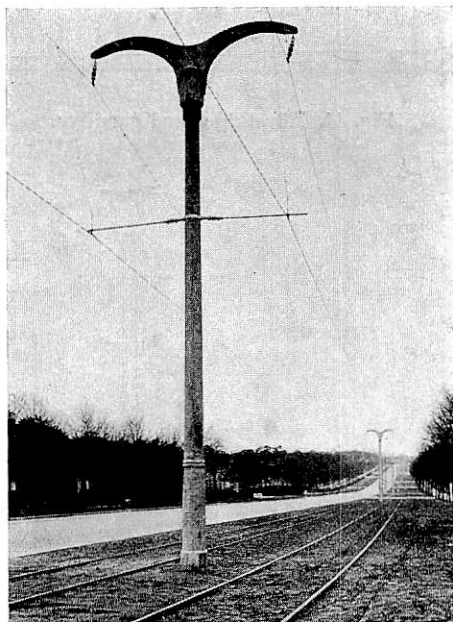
Betongstolpe med utliggare av betong, Heerstrasse, Berlin.
